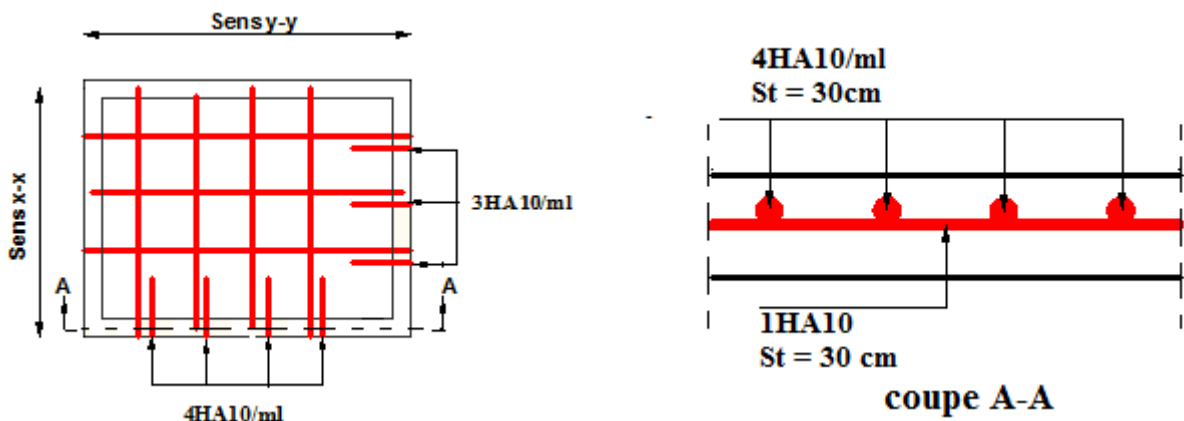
Schéma de ferrailage de la dalle pleine au-dessous de l'ascenseur.
